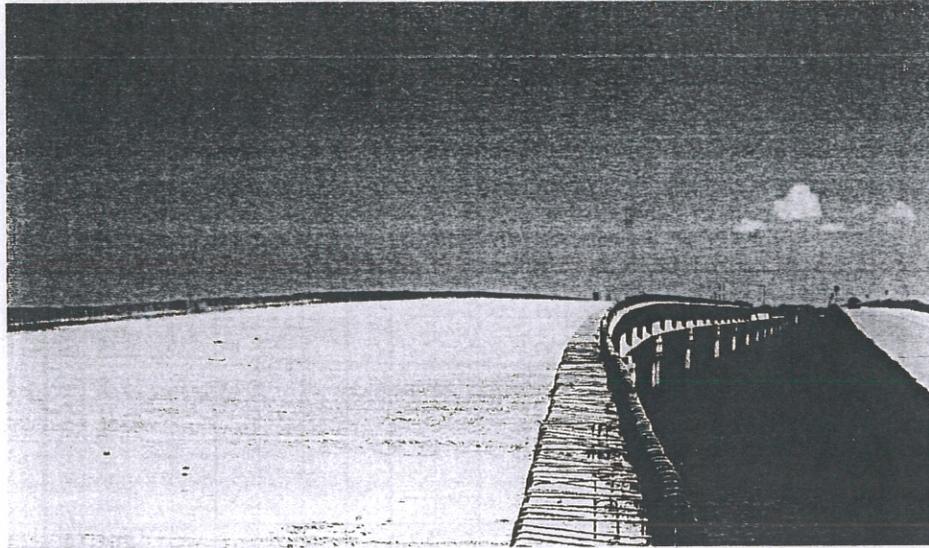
Losa de concreto construida, a la derecha el puente actual.
